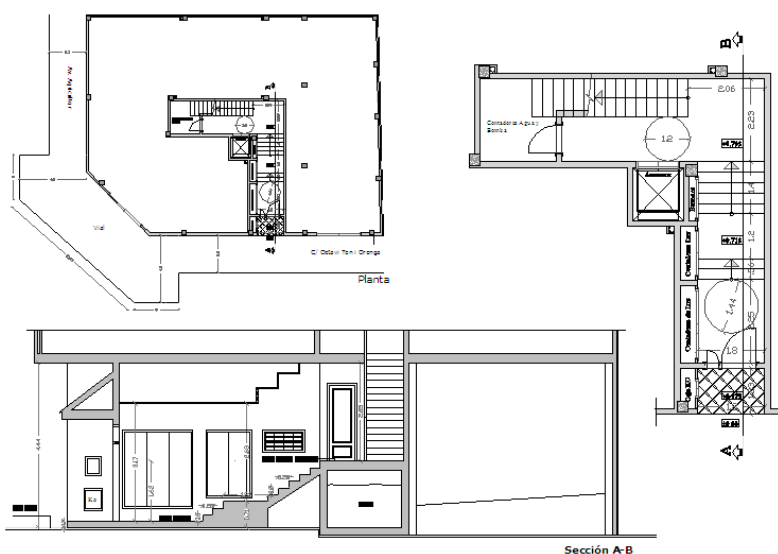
Plano accesibilidad [Anexo II. Planos]
